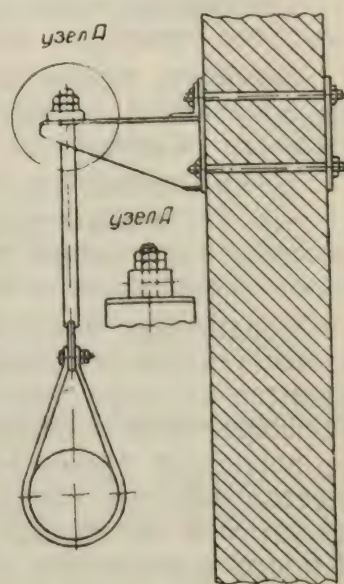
Крепление трубопроводов с помощью грушевидных хомутов.
